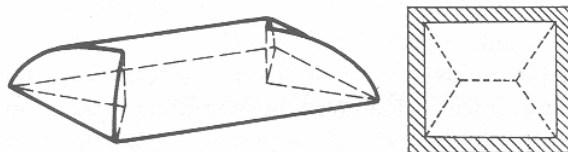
Klášterní klenba otevřená (Axonometrie) a Klášterní klenba otevřená s okosenými rohy a výztužnými pasy nad čtvercovým půdorysem
